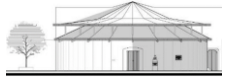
Trabajo en madera de pino en pilares, barandales y cubierta
